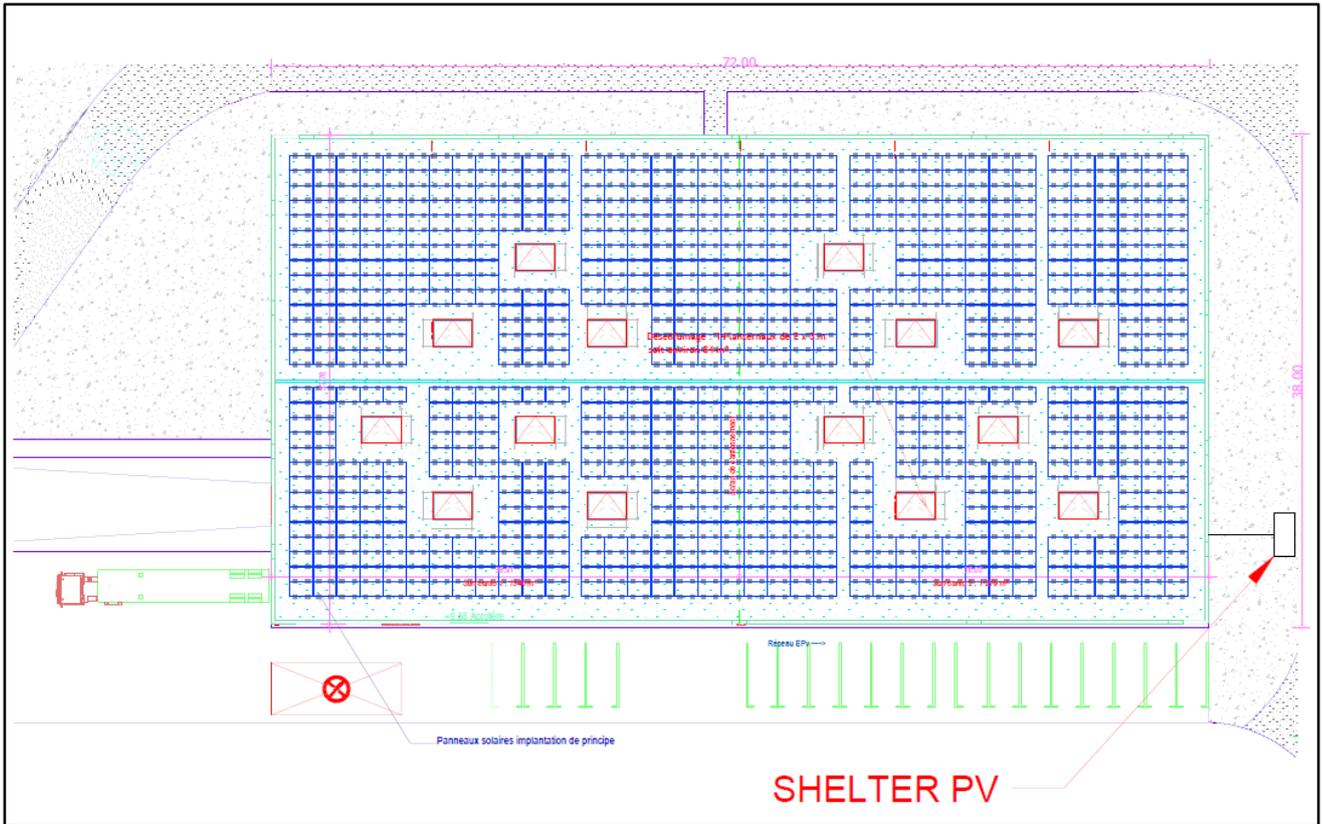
Plan d'implantation des panneaux photovoltaïques
